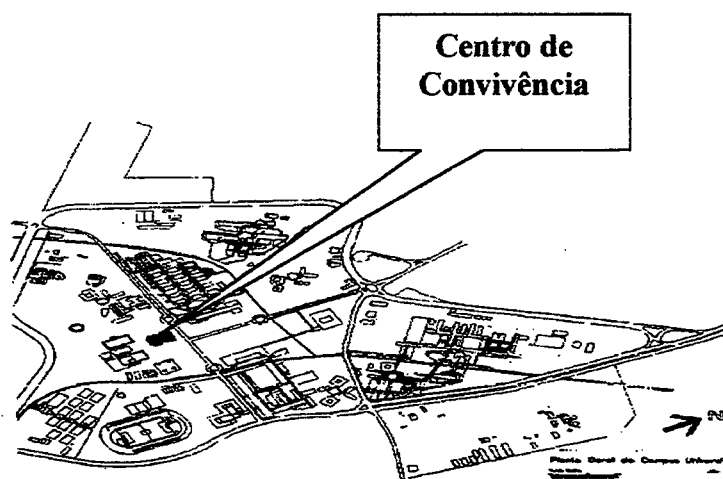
Planta de Situação Campus Universitário- UFSC/SC
